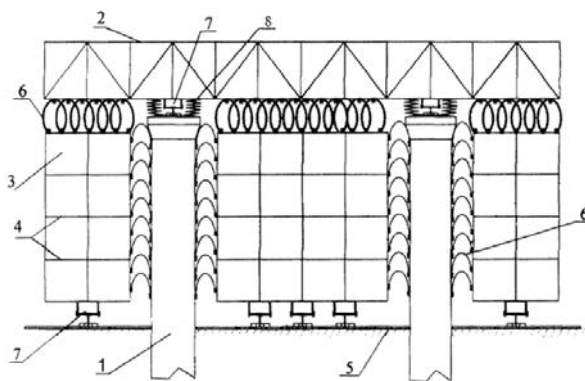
Сейсмостойкое здание подвесного типа: 1 – опорный ствол; 2 – двухконсольная ферма; 3 – подвесная часть; 4 – перекрытия; 5 – фундамент; 6 – упругие элементы; 7 – корректоры жёсткости; 8 – сейсмоизоляционное устройство
